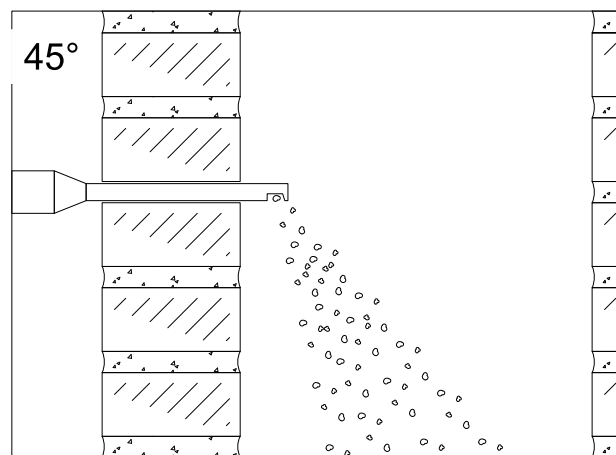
Einblasdüse mit gekröpftem Düsenauslass
